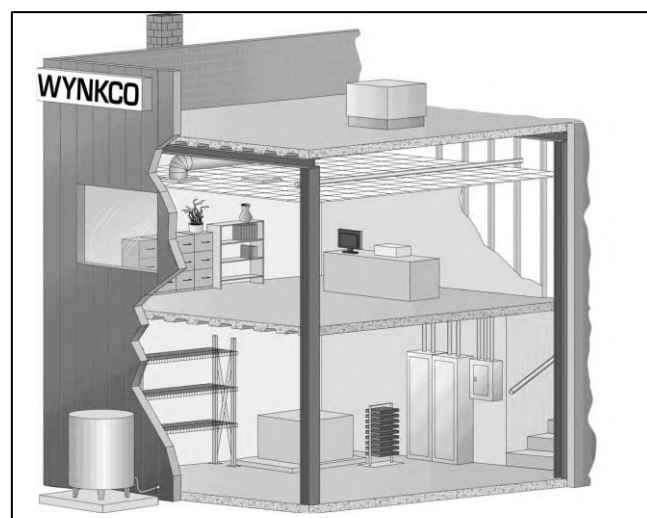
Vista 3D de edificio con elementos estructurales y no estructurales.
